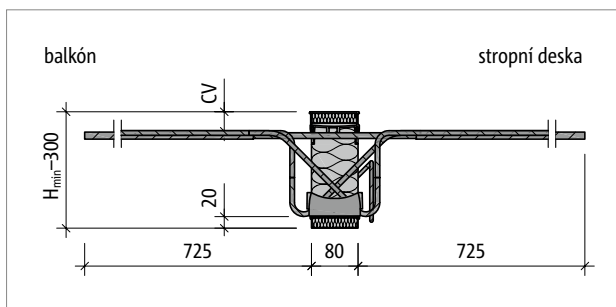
Schöck Isokorb® T typ KL-M10-V2: Půdorys prvku
